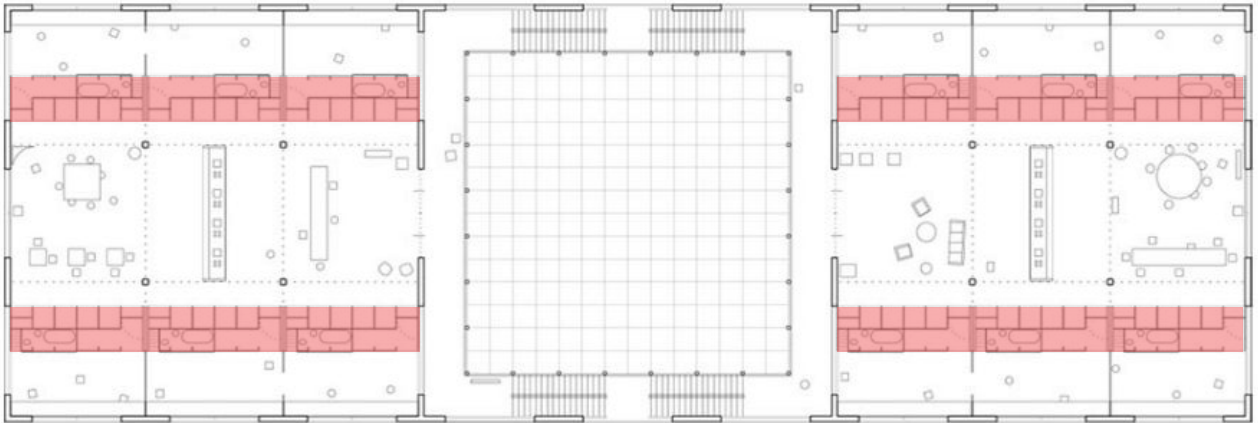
Grundriss Communal Villa - Villa Urbana, Dogma, 2017, hiddenarchitecture.net
